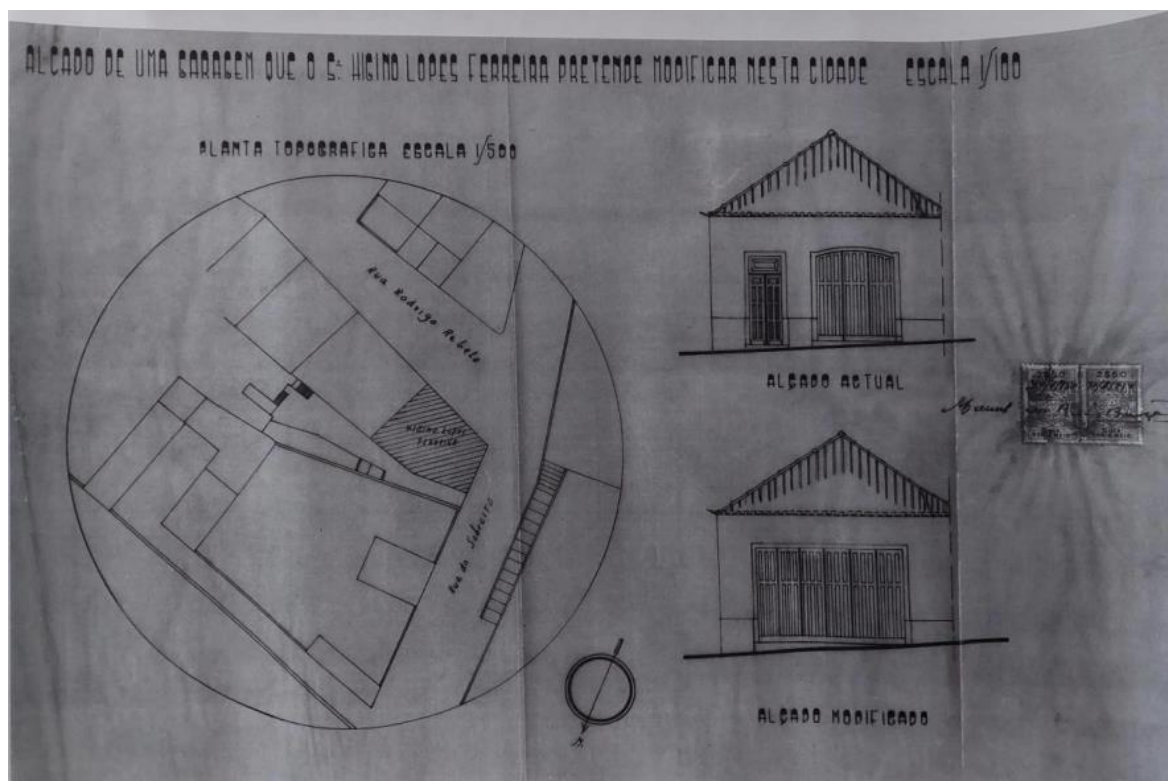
Planta e alçados do edifício bloco 1, (1950).
